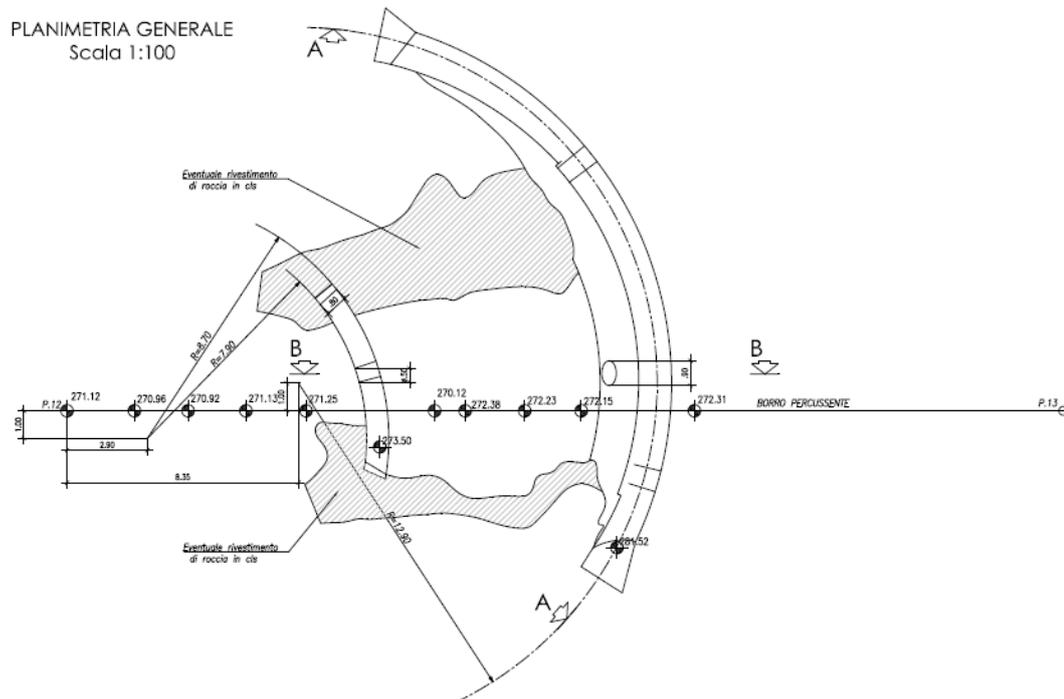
Sbarramento SA02 Percussente – Planimetria di progetto
